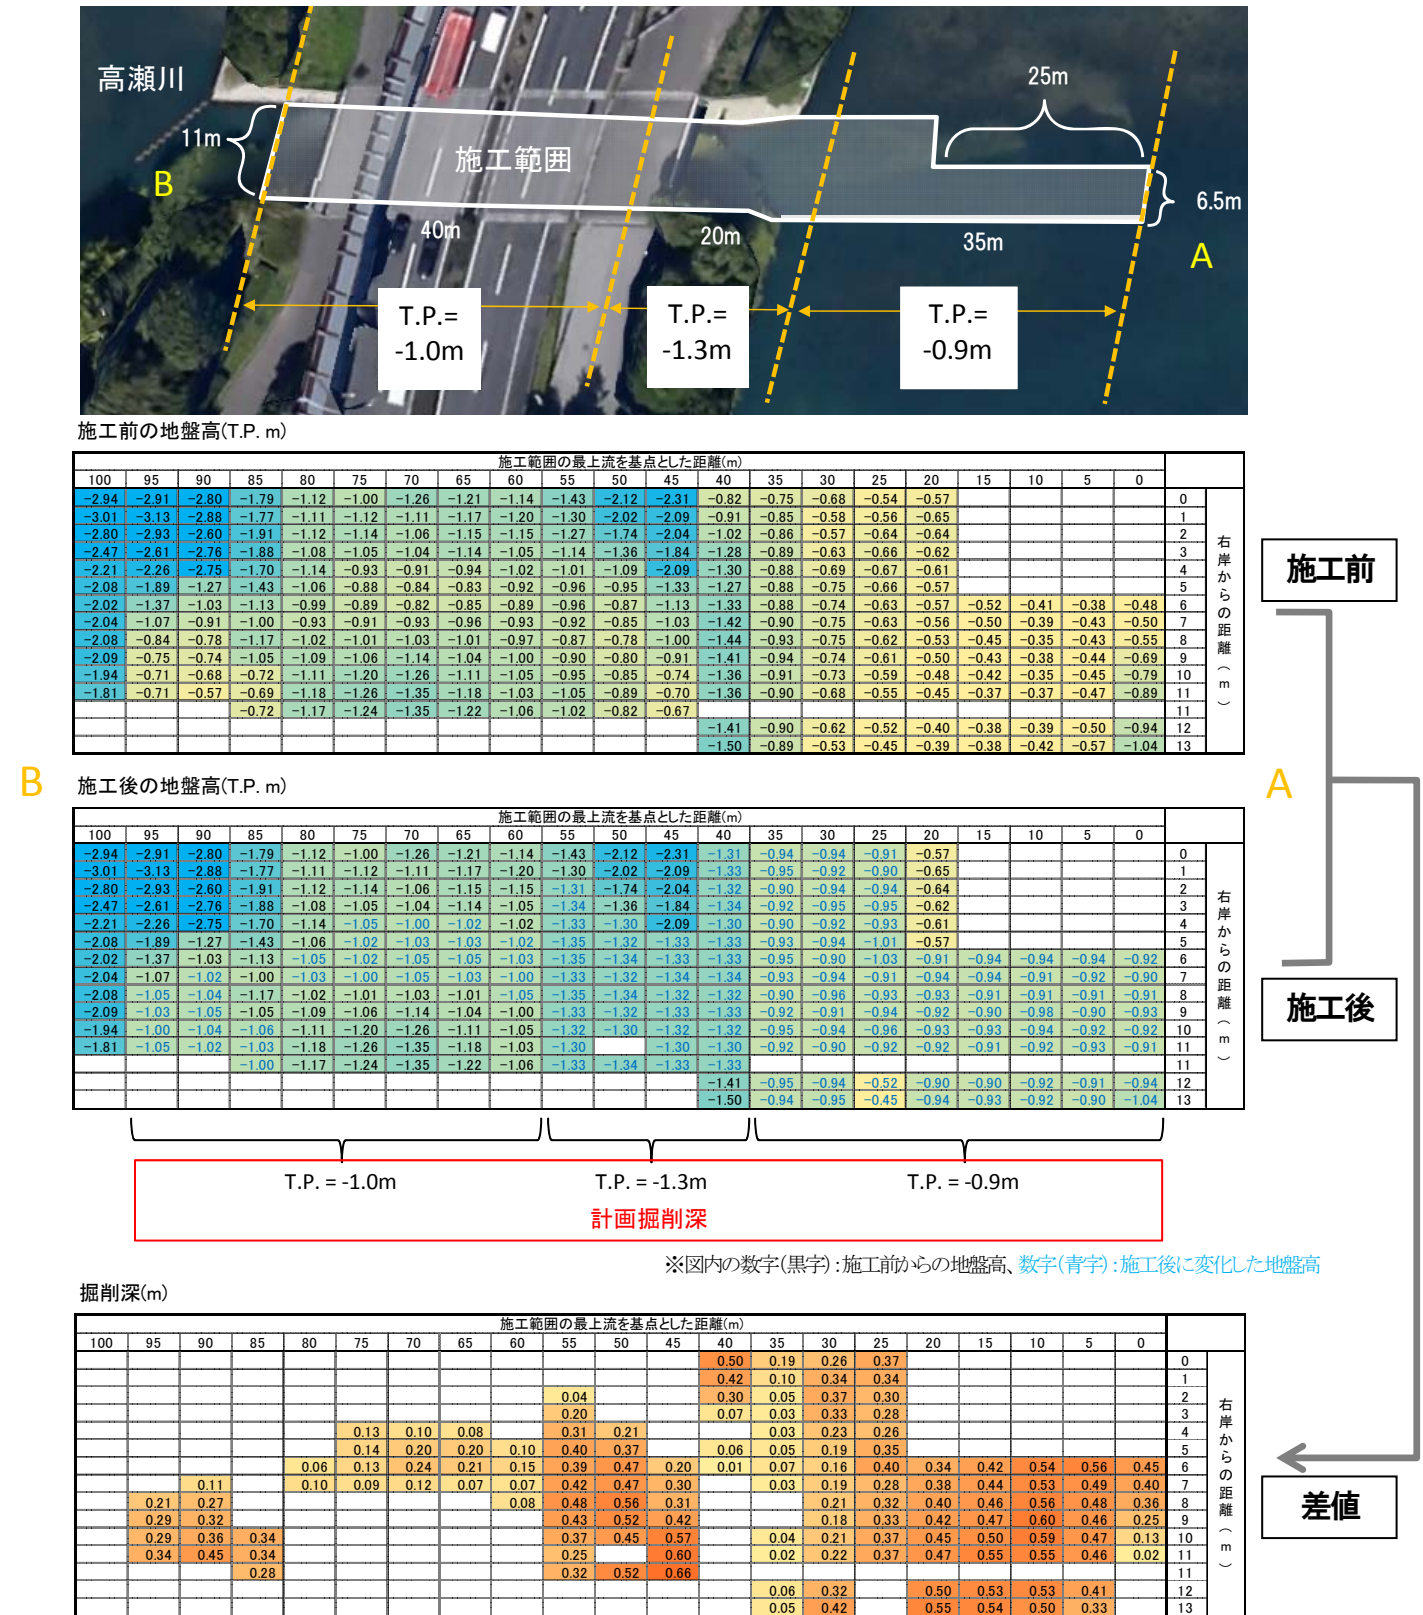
施工の位置と施工前後の地盤高の変化(単位:m)
